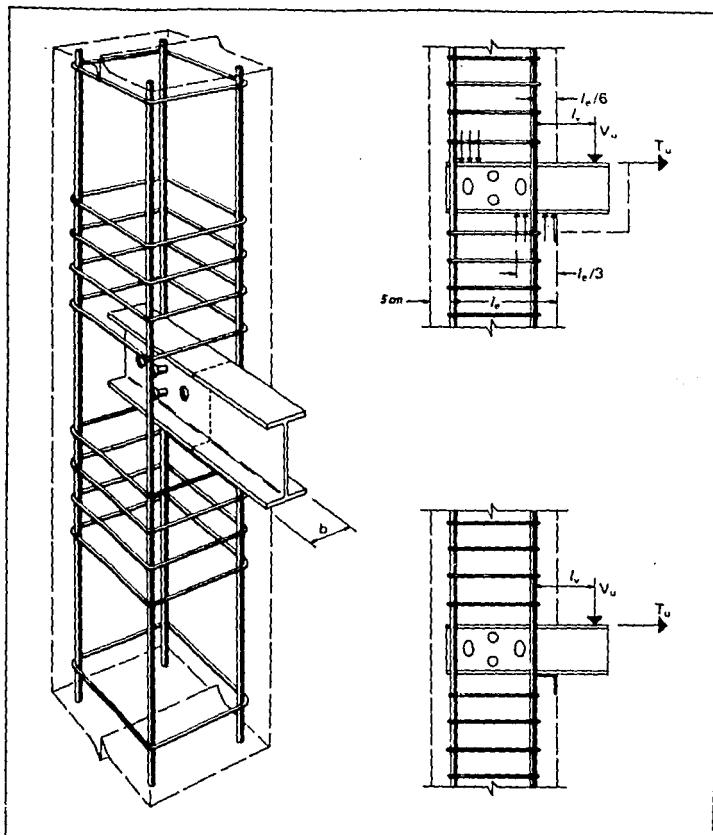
PERFIL EMPOTRADO DE ACERO ESTRUCTURAL.
